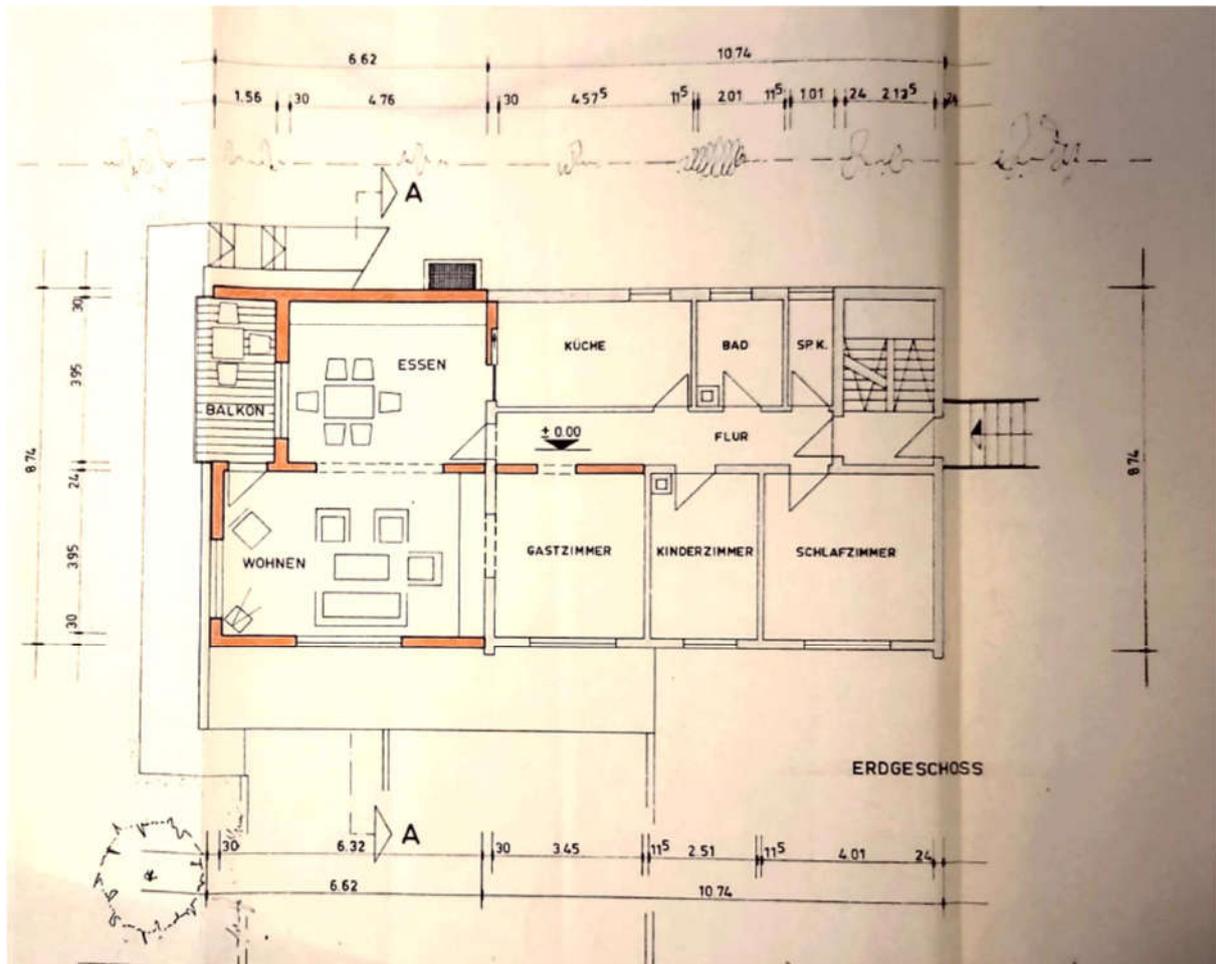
Grundriss Erdgeschoss mit Erweiterung
